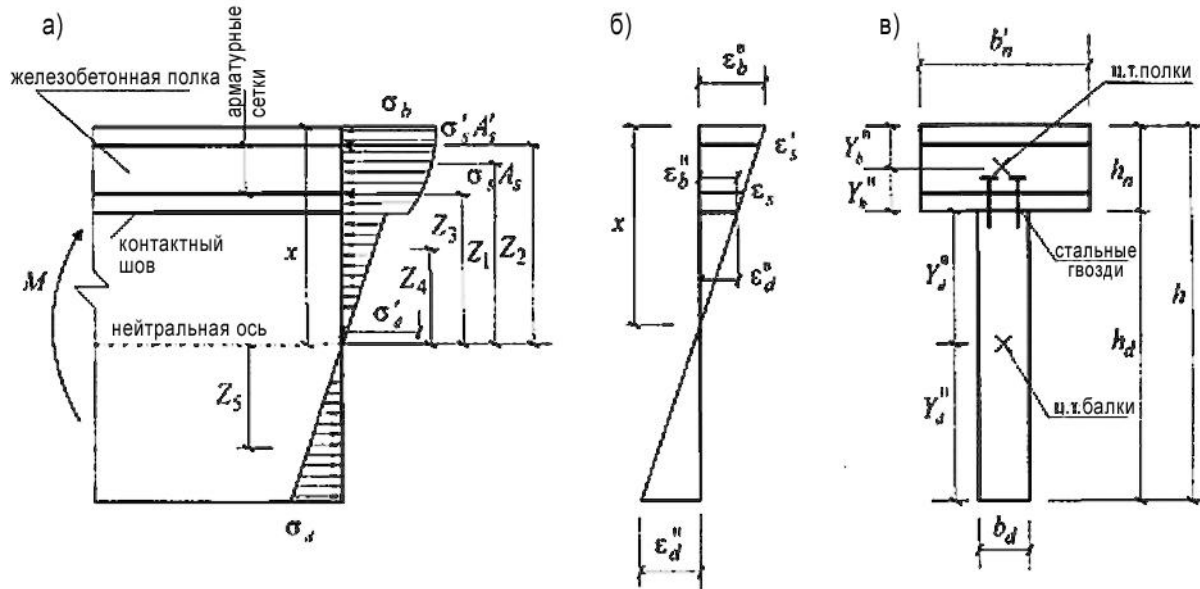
Расчетная схема усилий, эпюры напряжений и деформаций при расчете выносливости нормальных сечений деревожелезобетонных изгибаемых элементов без учета податливости связей сдвига:
